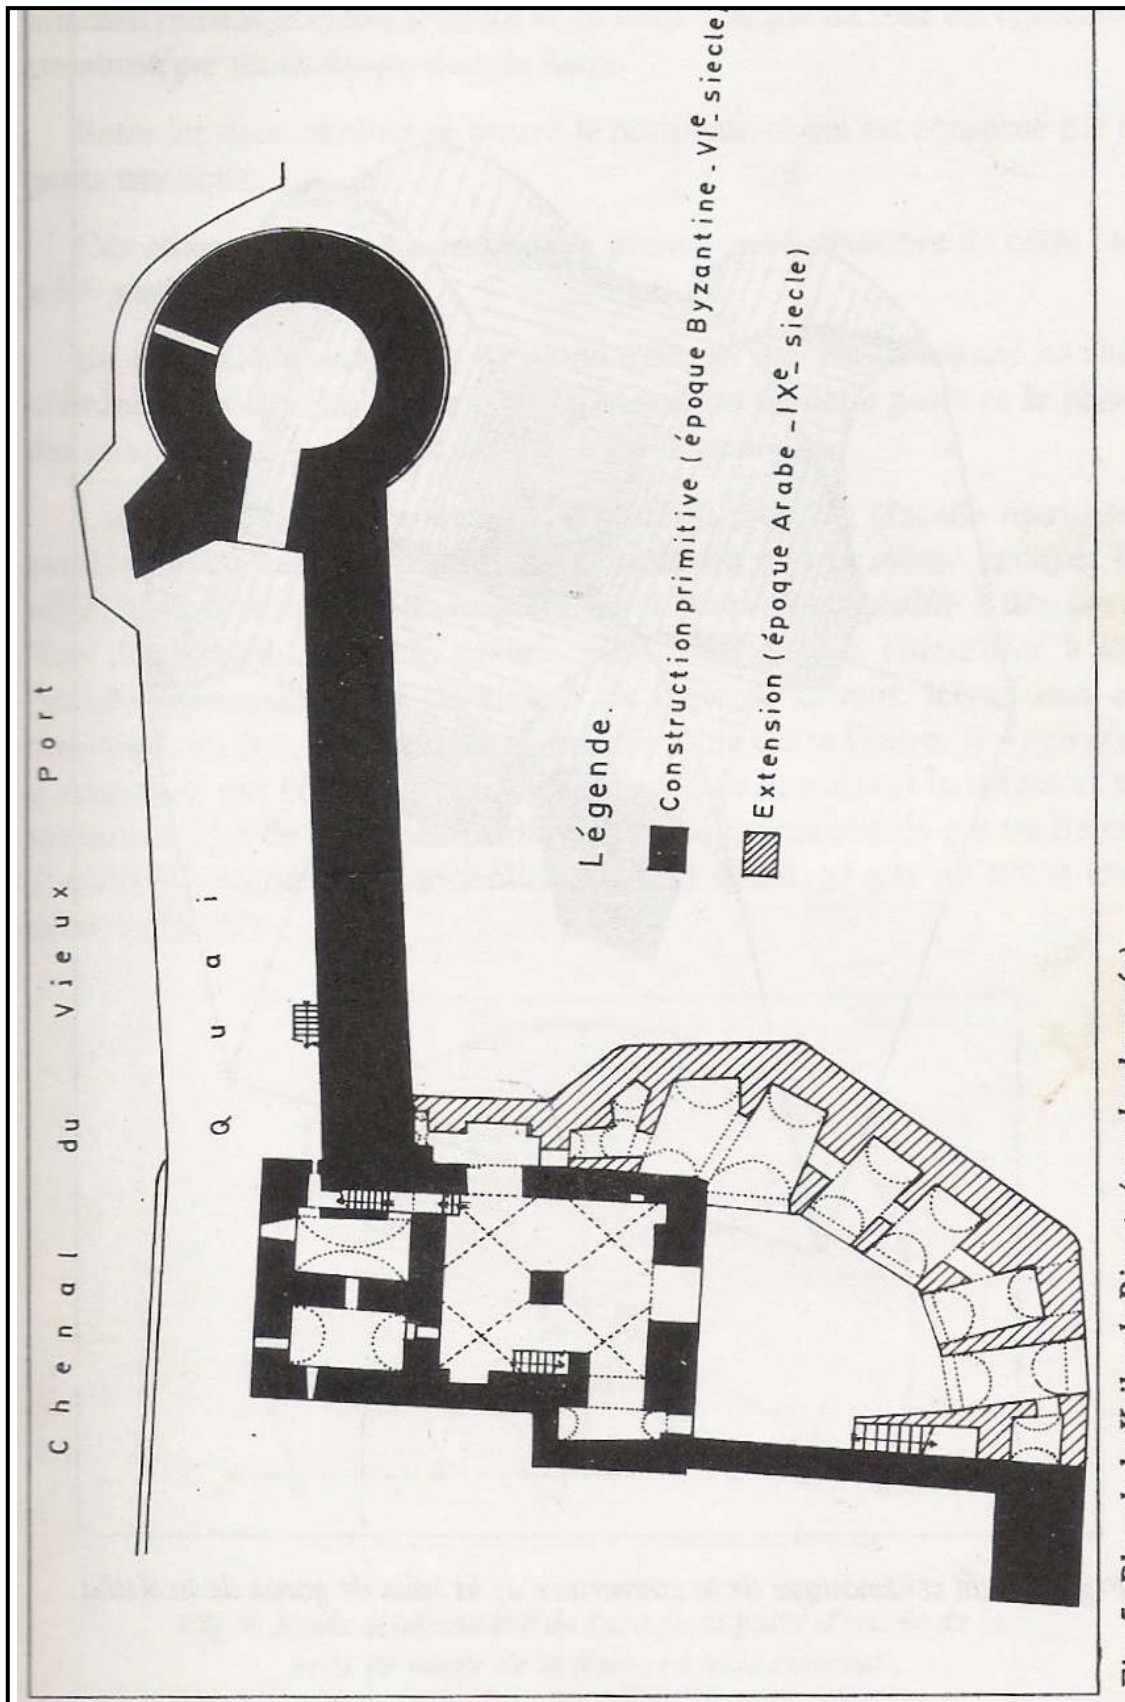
Fort al-Qsiba – plan du rez-de-chaussée d’après H. Bouita
